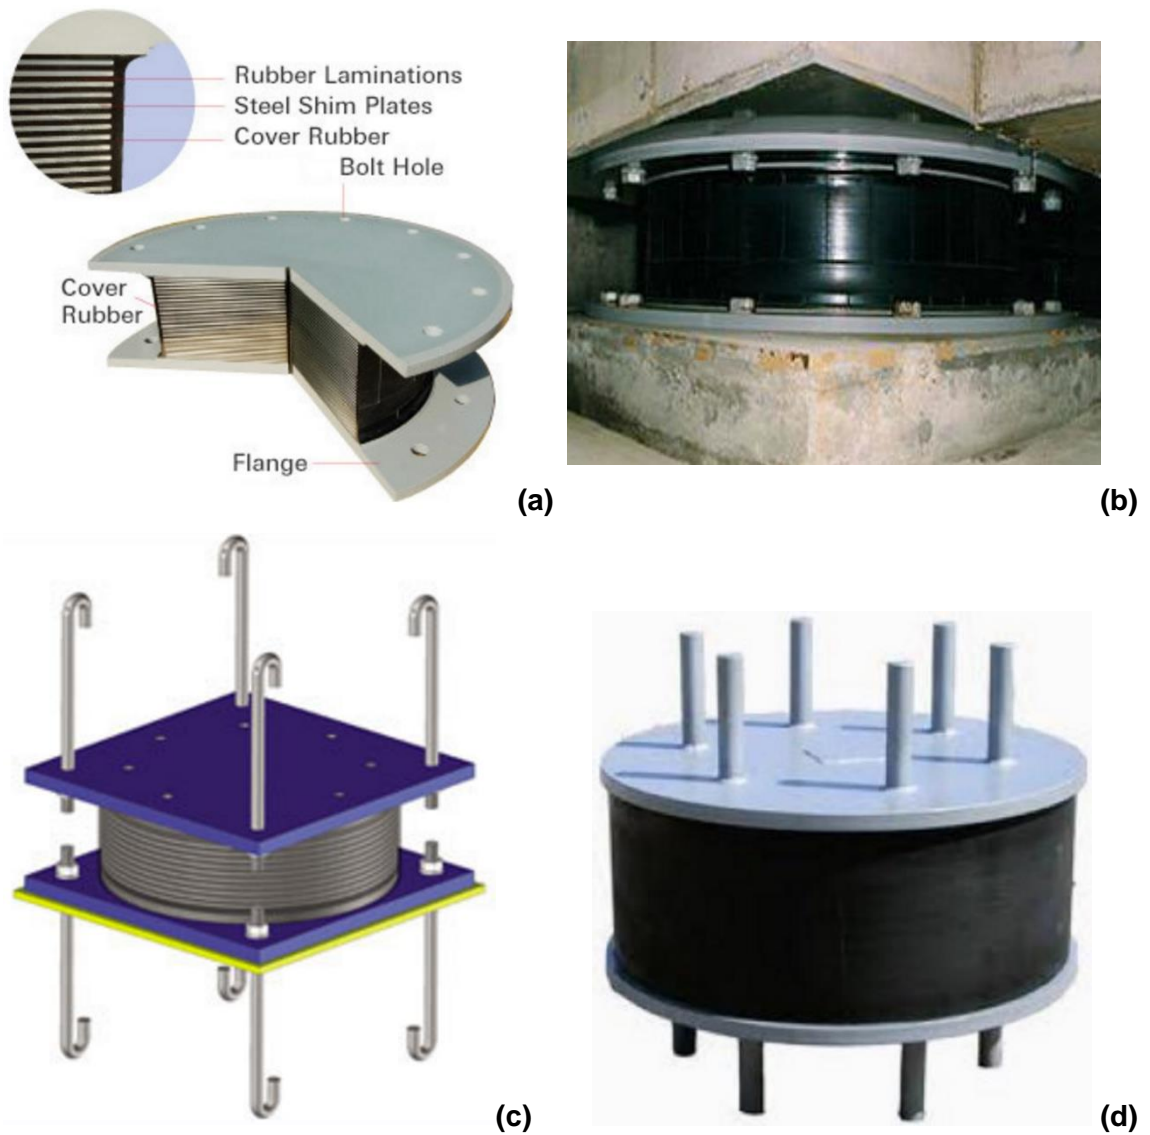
Dispositivi di isolamento HDRB. Fonti: (a) Bridgestone Corporation; (b) Mageba USA; (c) Arsan Kaucuk; (d) Zaoqiang Dacheng Ruber Co..
